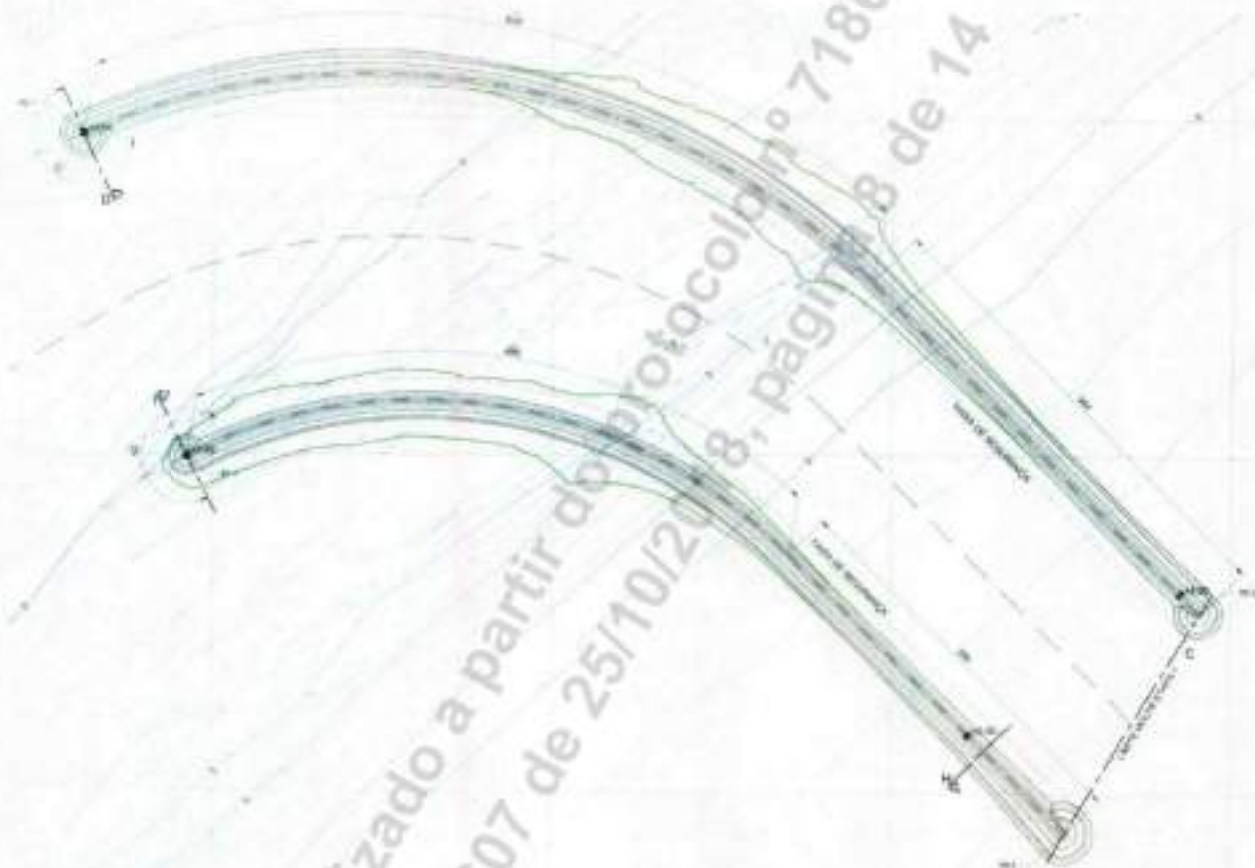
Arranjo geral dos molhes norte e sul – Etapa 1
